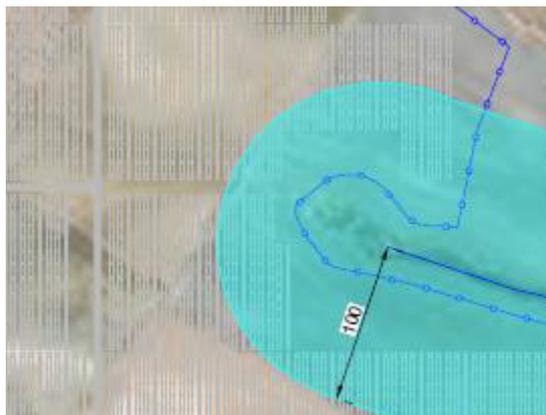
Detalle distancias entre cauce y módulo de generación fotovoltaico LAS MAJAS VI A
